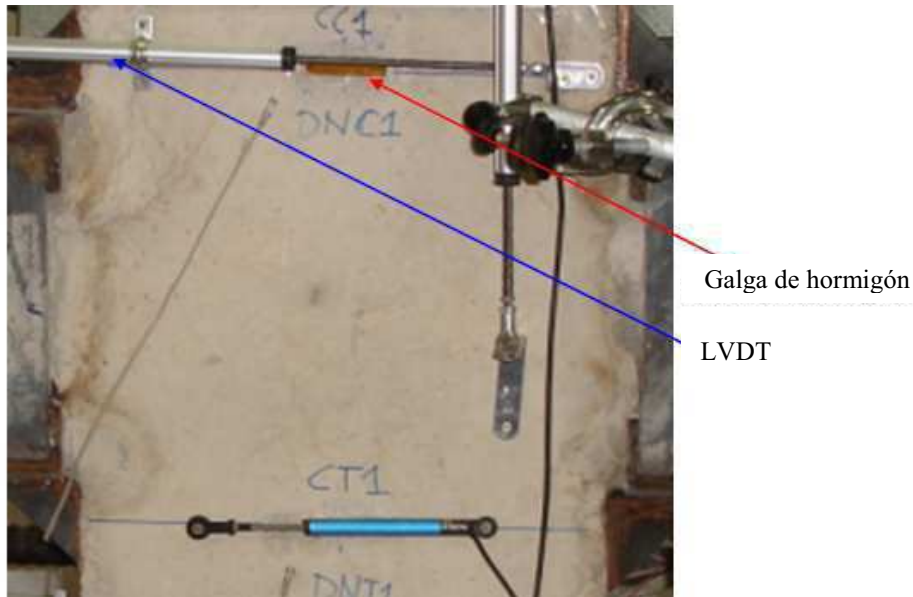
Instrumentación dispuesta en el nudo viga-soporte
